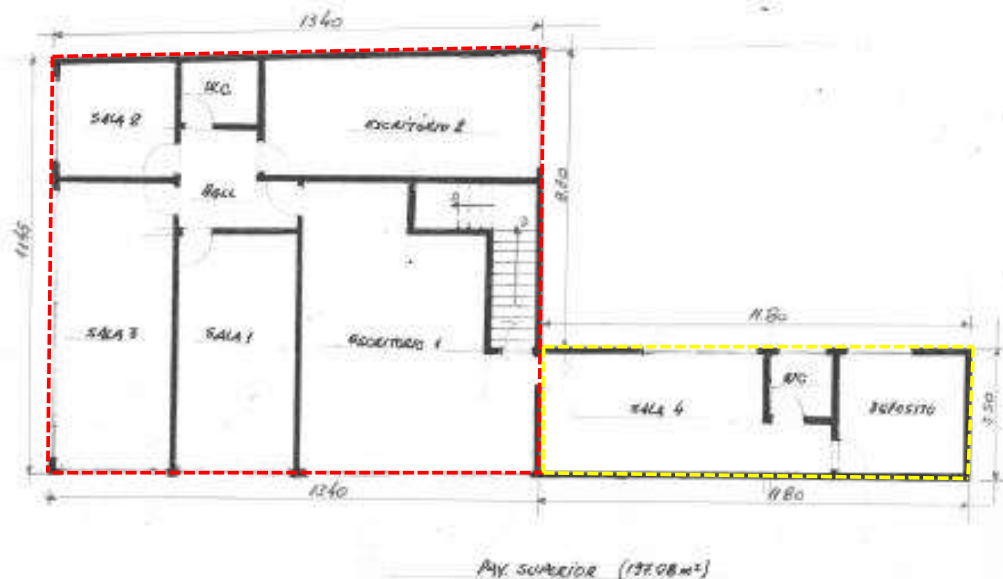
Croqui esquemático representando o pavimento superior da edificação em dois pavimentos, construída em duas etapas, com área aproximada de 197,08 metros quadrados. Área com perímetro destacado em vermelho refere a fase 1 da construção do prédio e a área em amarelo a fase 2.
